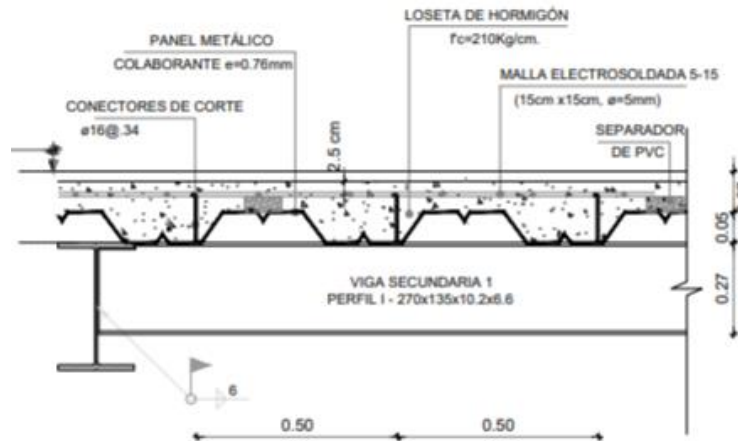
Sección de losa de panel colaborante sobre vigas. Elaboración propia, 2019.
